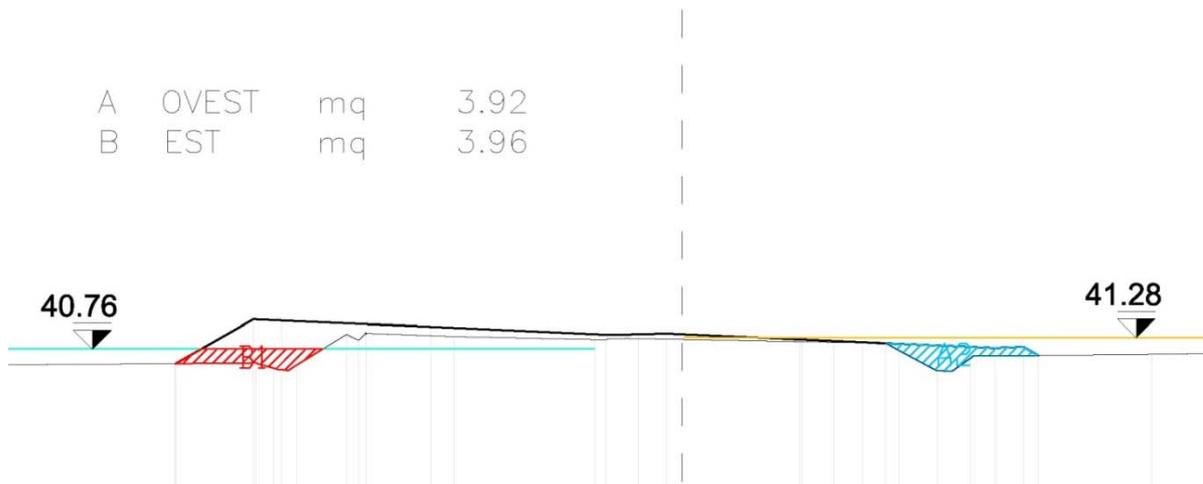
Sezione stradale tipo, con individuazione dei volumi sottratti all'esondazione.
